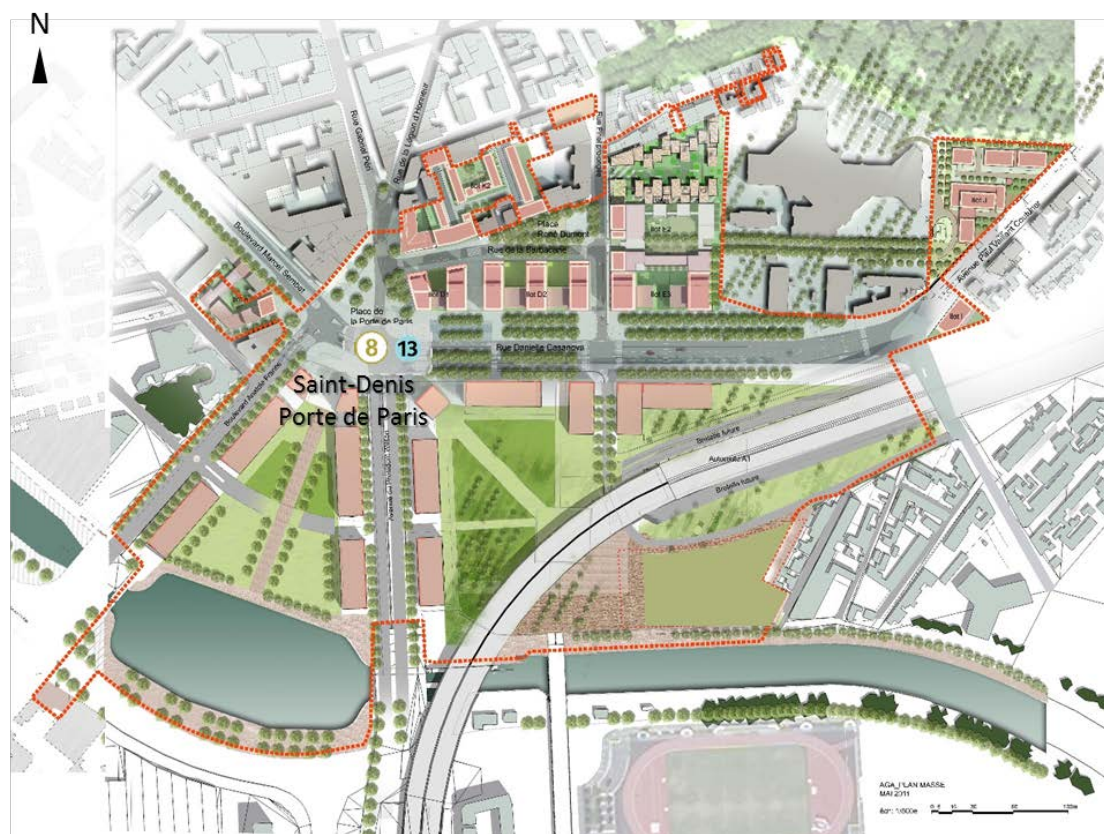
Plan masse de la ZAC Porte de Paris (Source : Plaine Commune)
